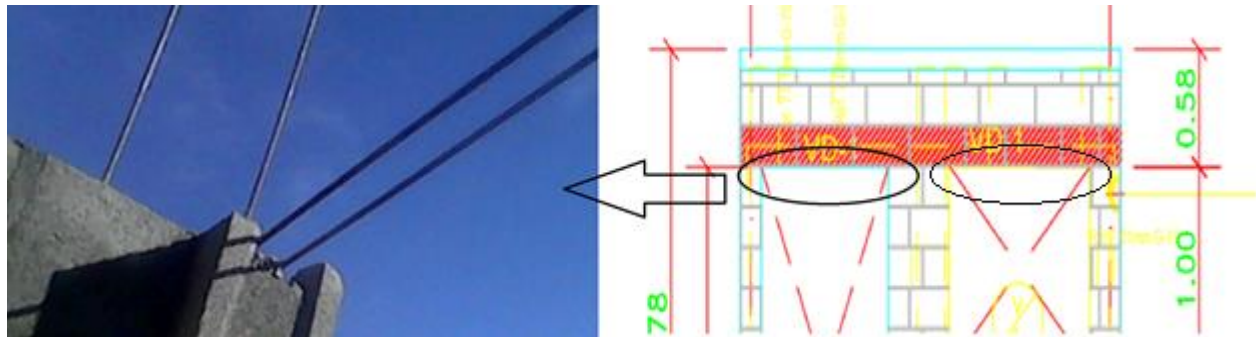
Refuerzo horizontal superior para vanos, Eje A
